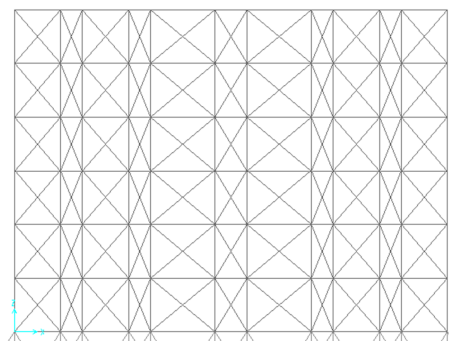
Configuração dos Planos de Contraventamento Vertical Com Elementos de Contraventamento Pequenos
